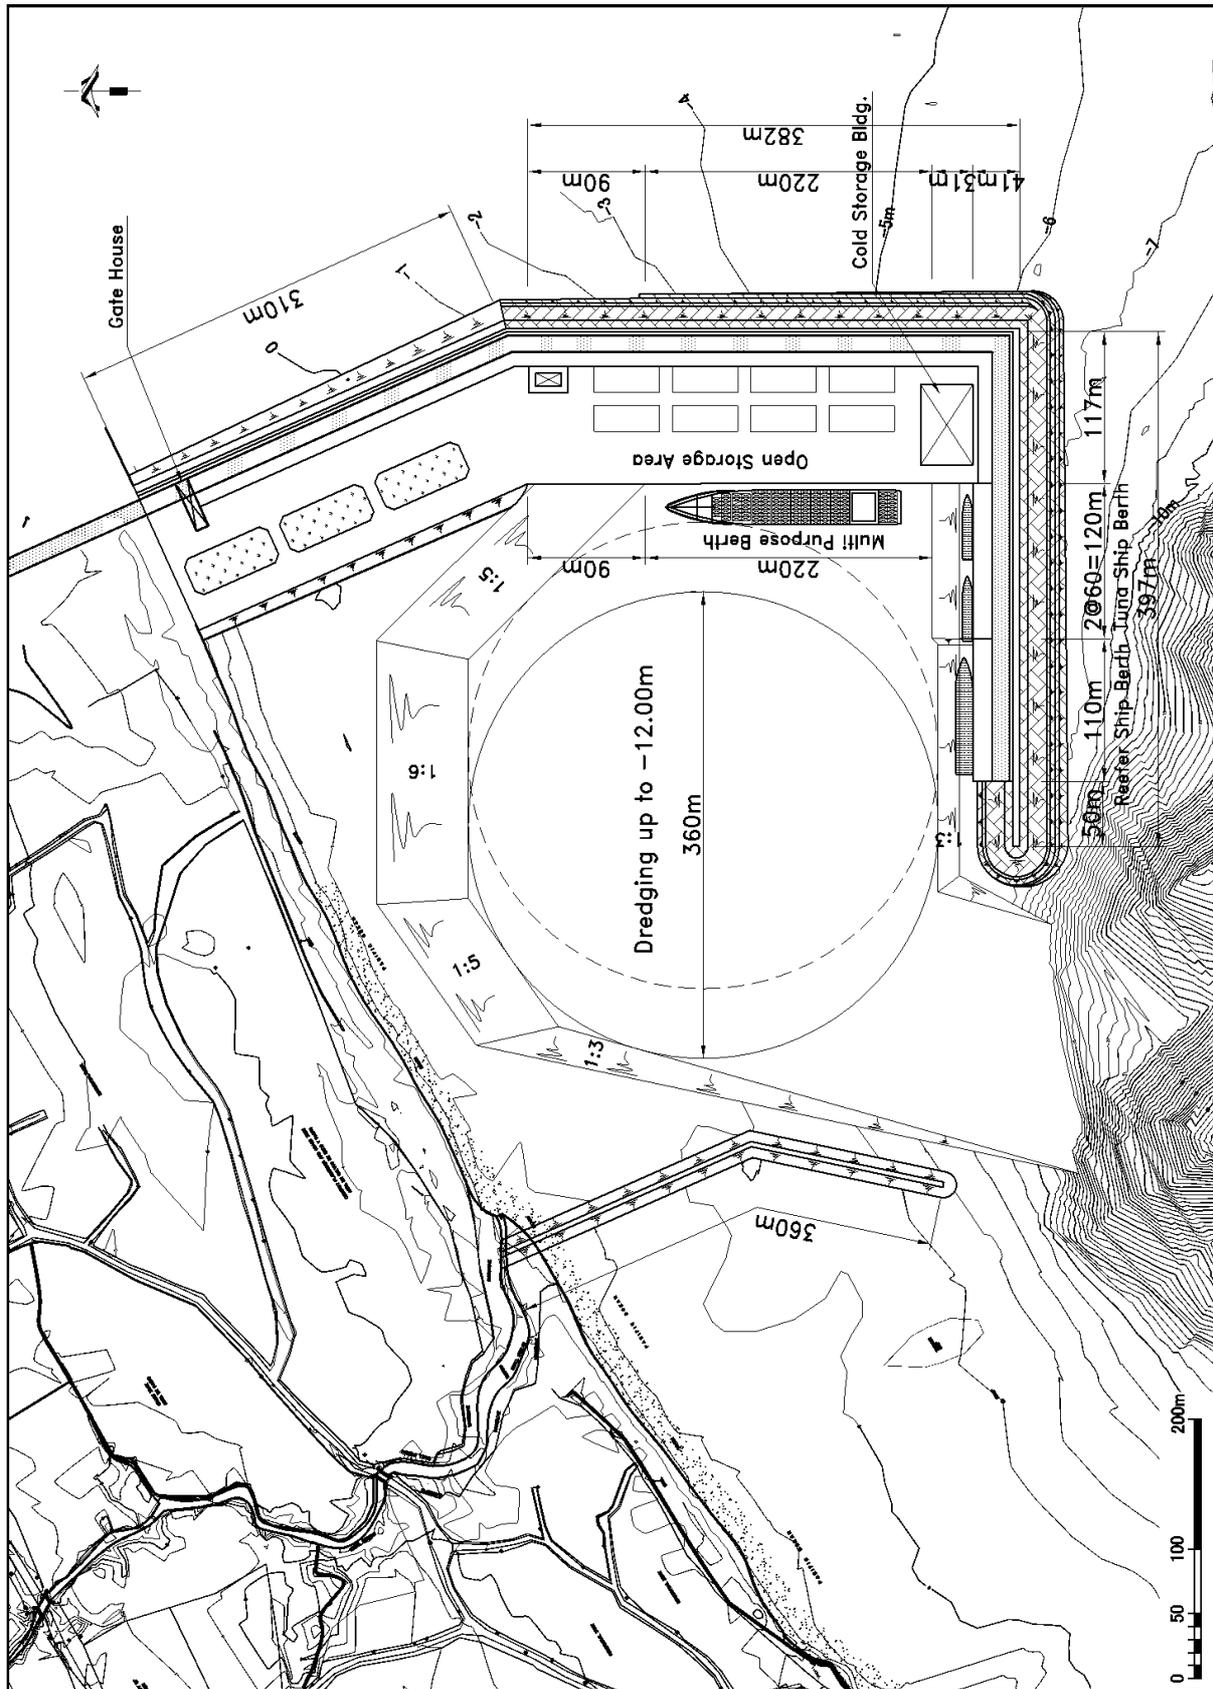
Disposición General del Plan de Instalaciones asarine Facilities
